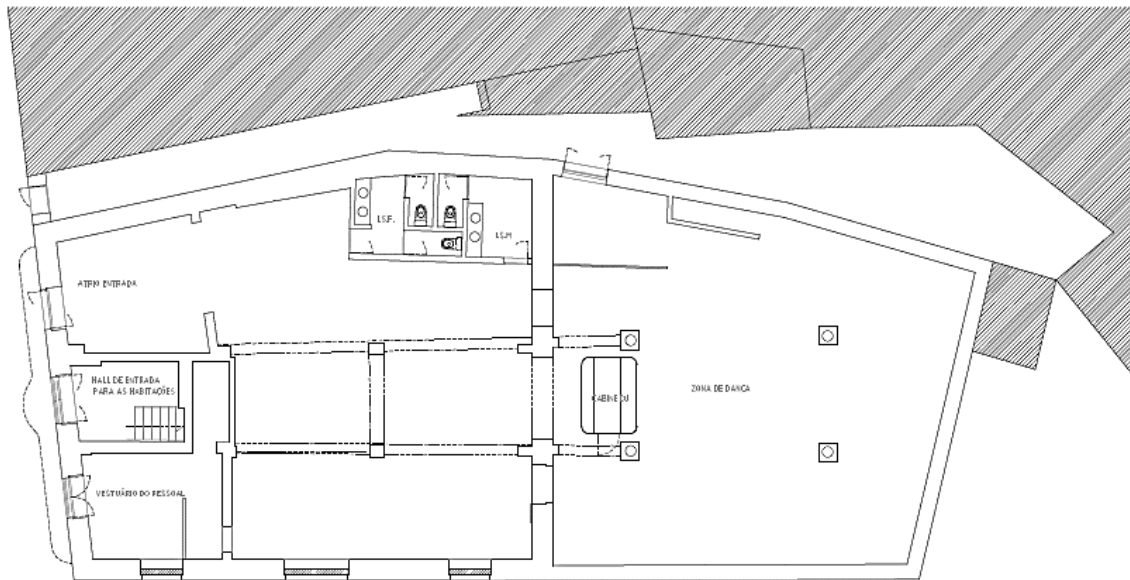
Planta 1 à cota do balcão – Esc.1/200 – Autora do projeto
